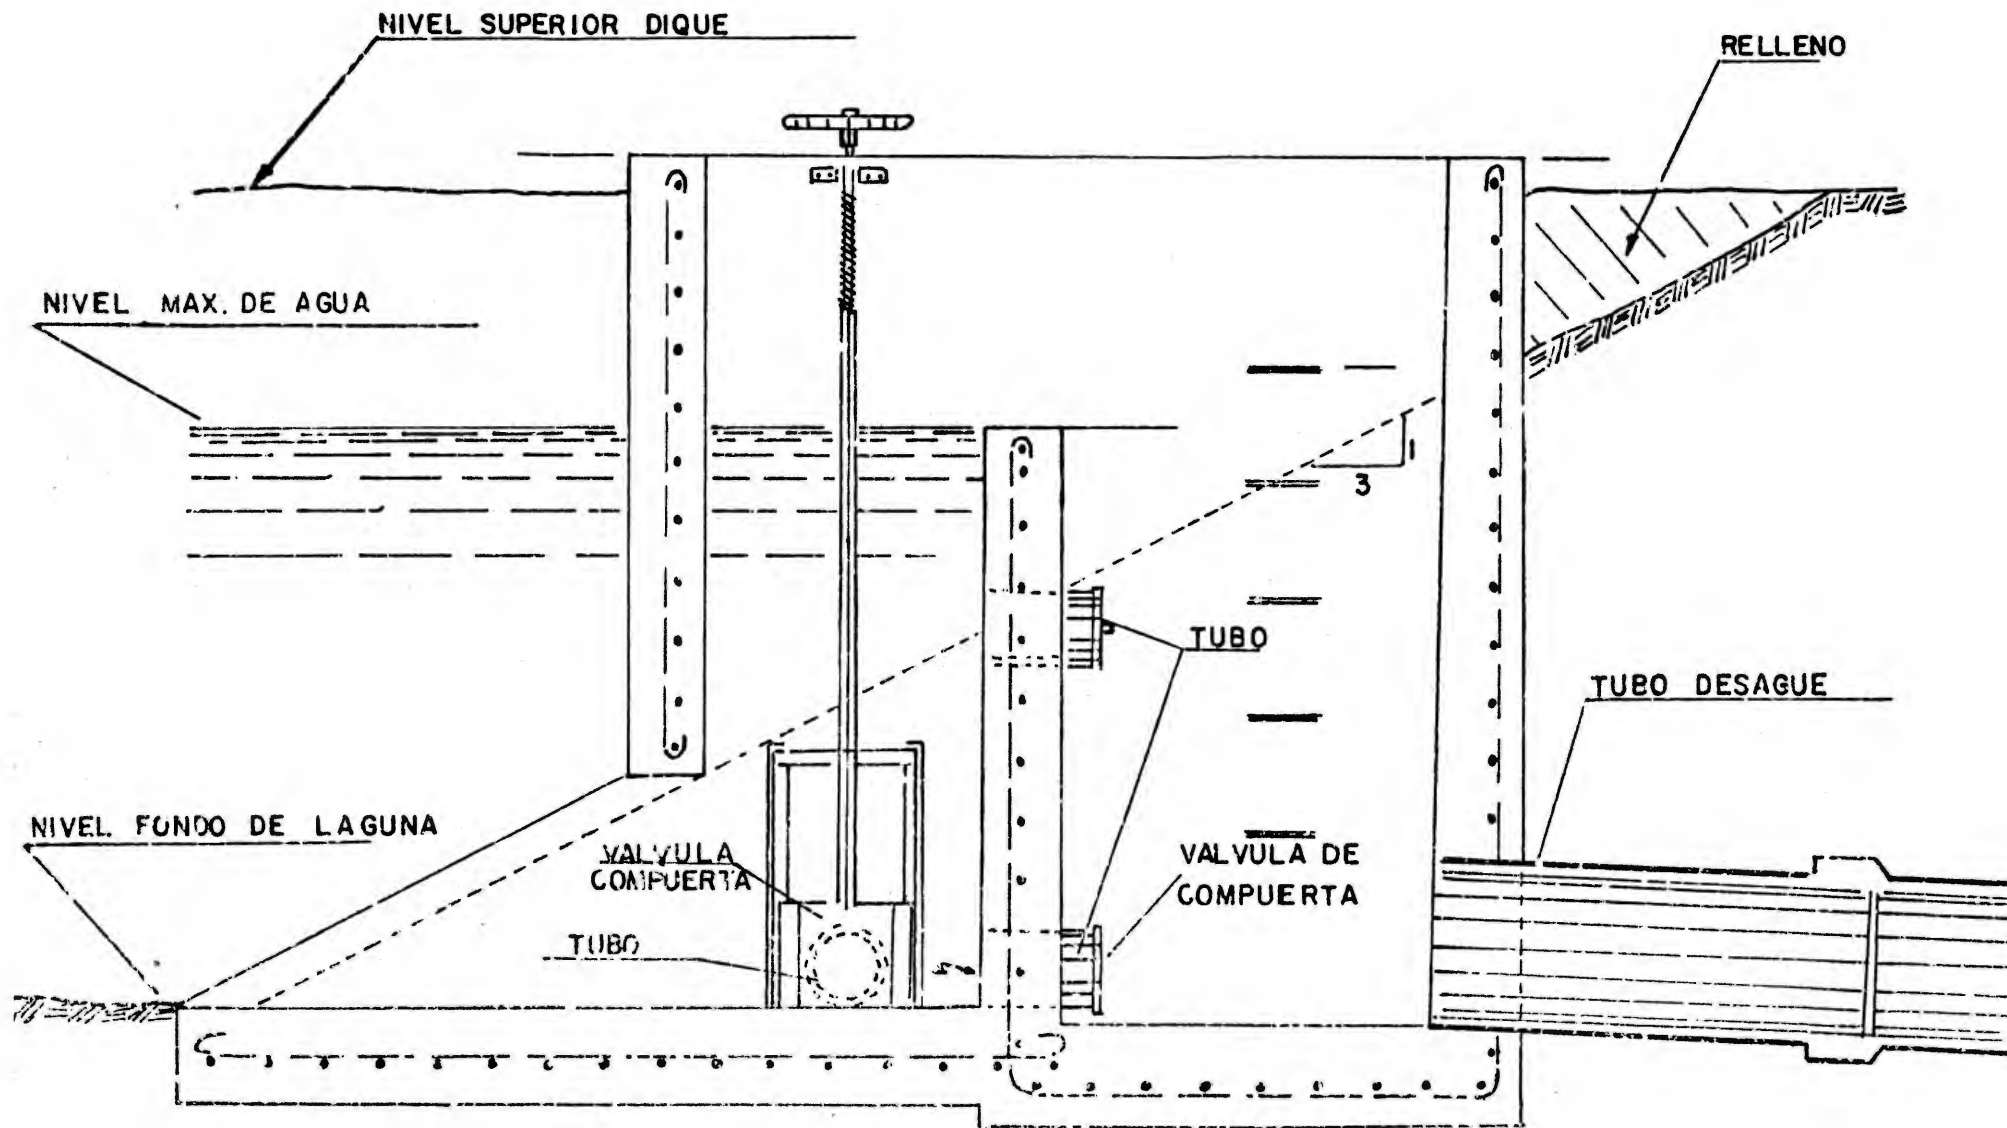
DETALLE DE LA ESTRUCTURA DE SALIDA
